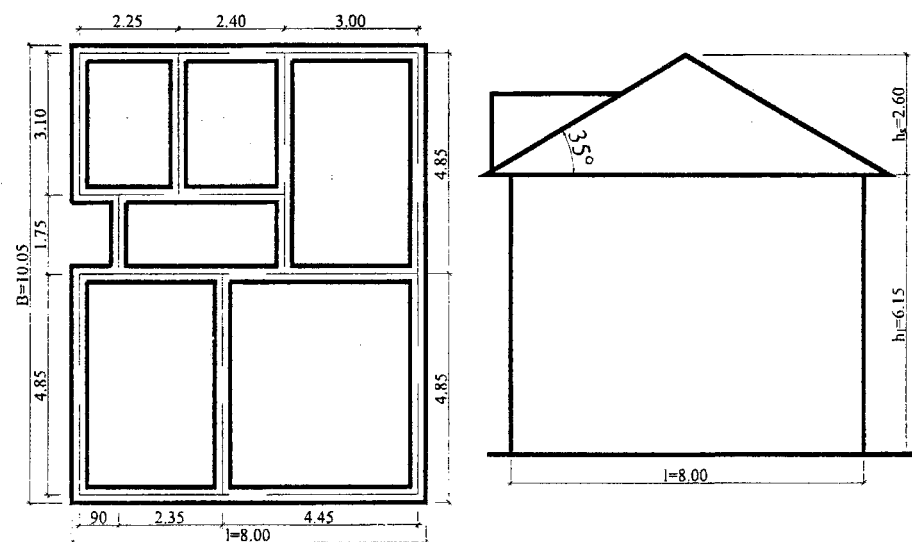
Dimensiunile în plan și în elevație ale clădirii
